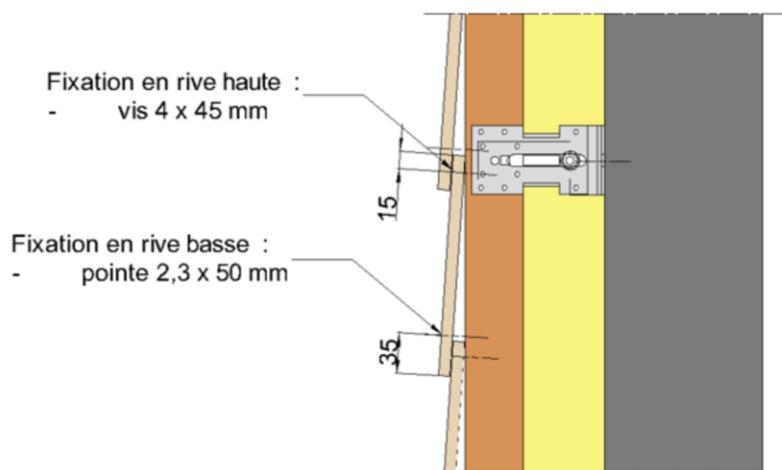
Fixation Rive haute et rive basse de la lame CEDRAL LAP pose horizontale
